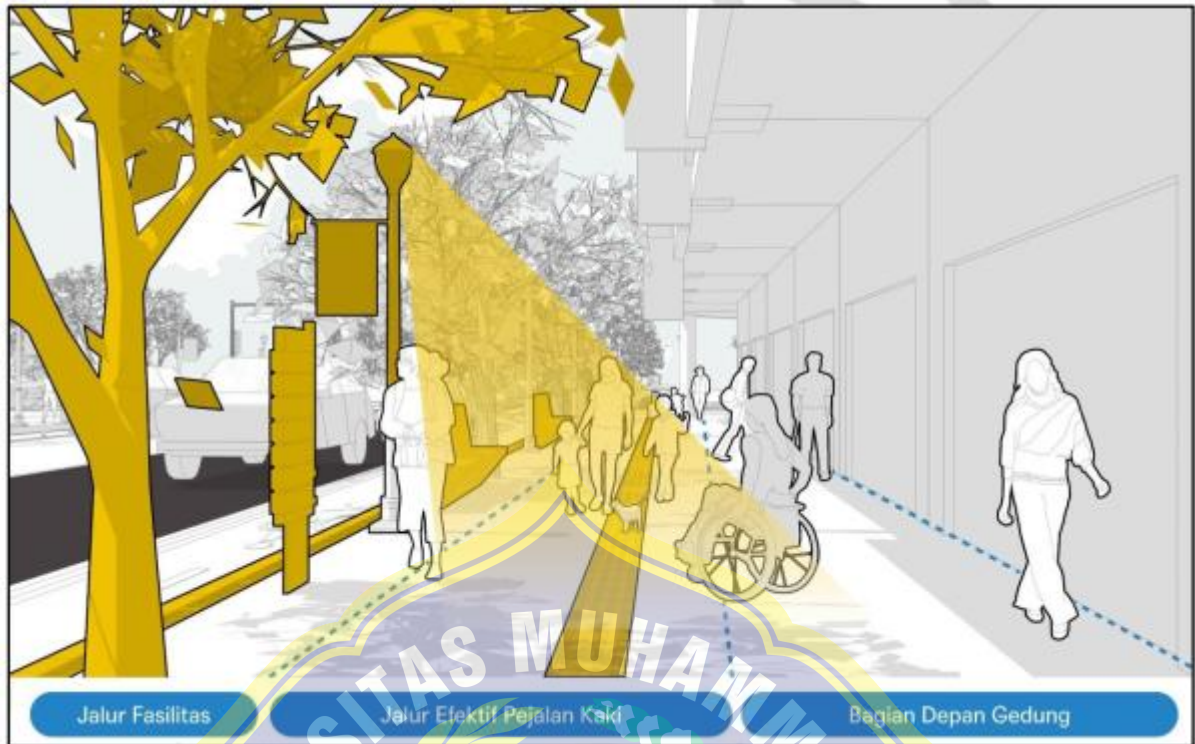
Trotoar di sepanjang lahan dengan tepi parkir
